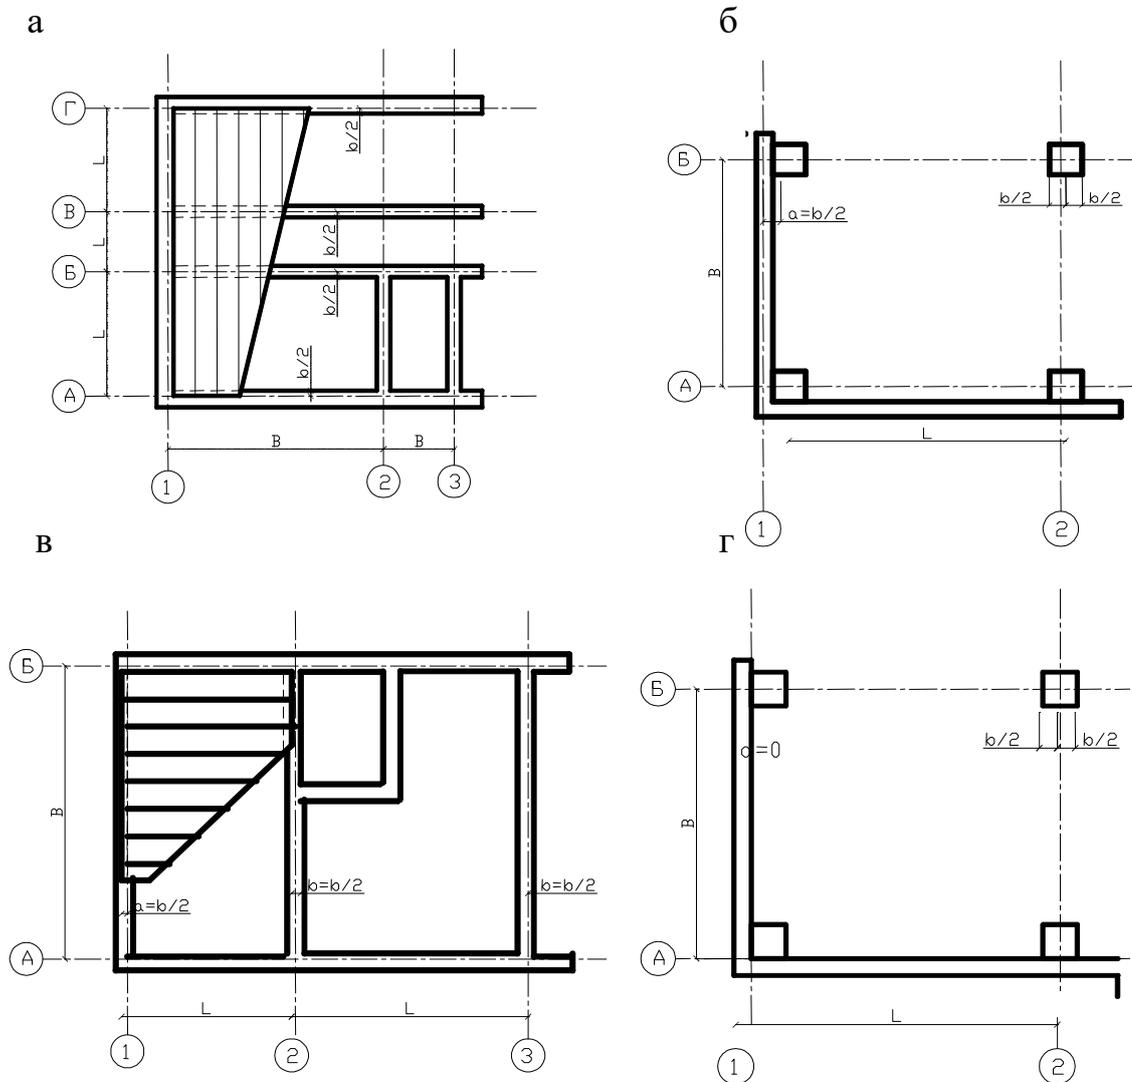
Примеры привязки стен к модульным разбивочным осям в плане здания: а – здание с продольными несущими стенами (привязка $b/2$); б – то же, с поперечными (привязка наружных продольных стен нулевая); в – крайний пролет каркасного здания (привязка нулевая); г – то же, привязка $b/2$; В – шаг, L – пролет
